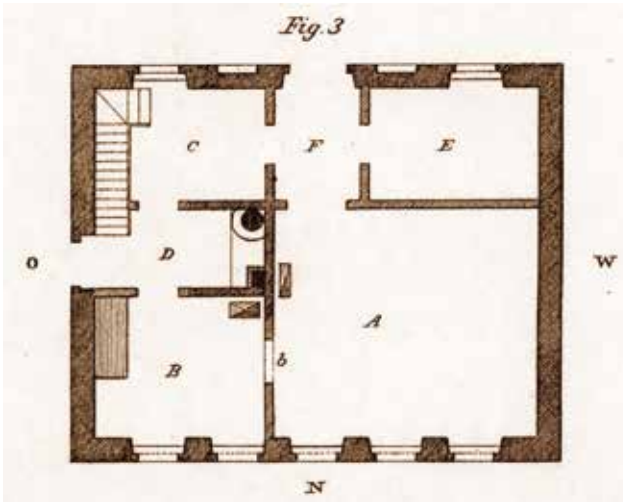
Grundriss des Erdgeschosses des Leichenhauses in Weimar. (aus: Carl Schwabe, *Das Leichenhaus in Weimar ...*, Leipzig 1834, Tafel I, Ausschnitt)
